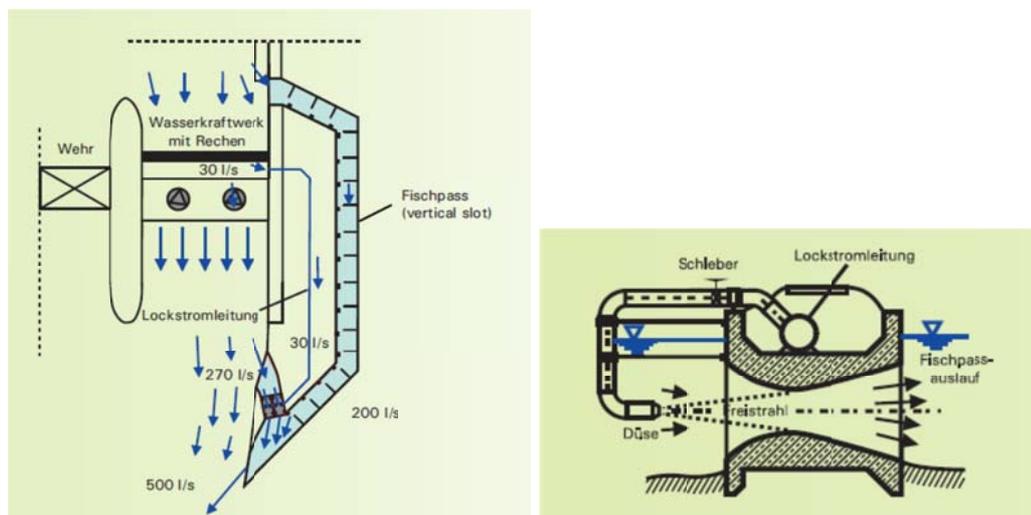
Prinzipskizze einer Lockstrompumpe (Quelle: Hassinger).
